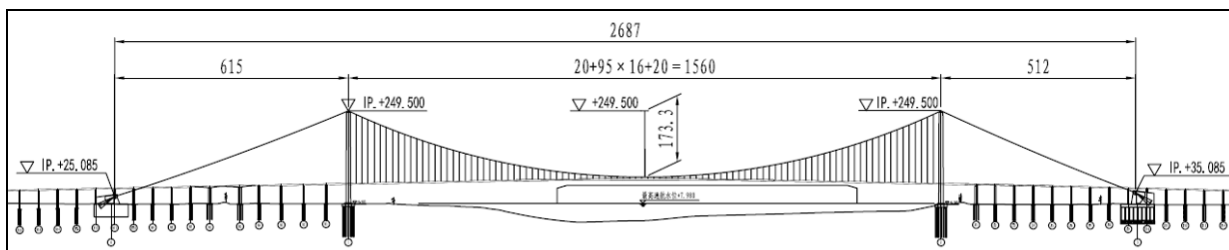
主跨 1560m 悬索桥方案桥式立面布置图 (单位: m)
